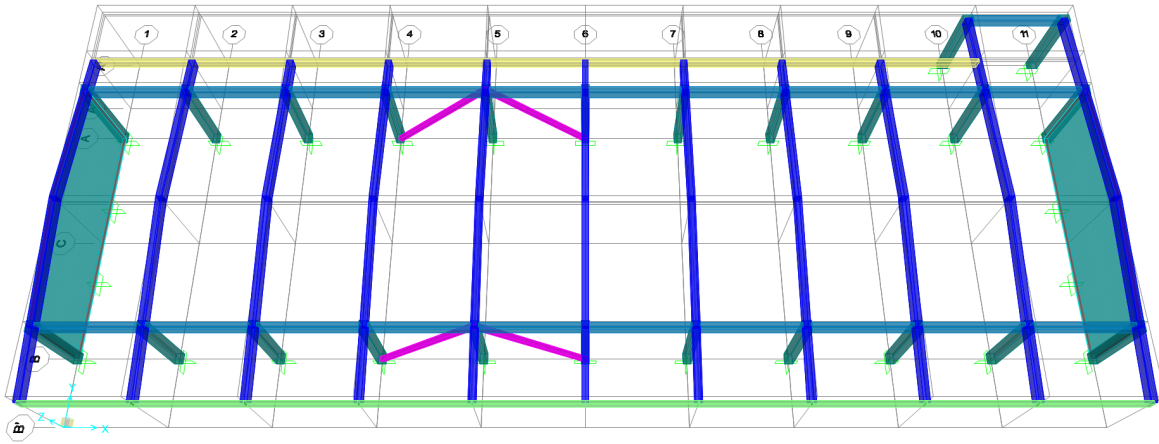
Propuesta de rehabilitación 2: Contraventeos metálicos + Muros diafragma
